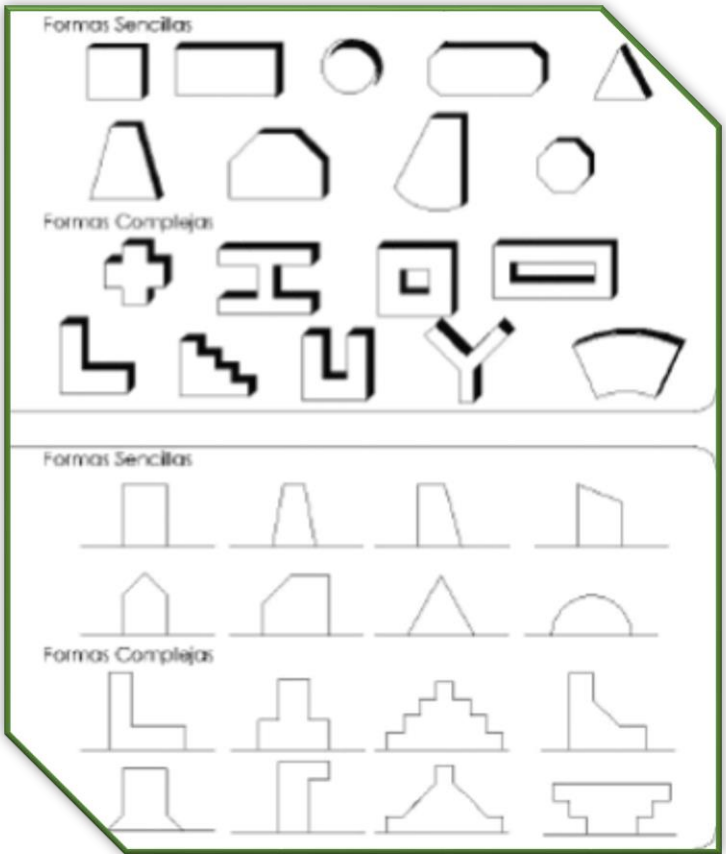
Formas Sencillas y Complejas en Planta y Elevación para Establecimientos de Salud. Fuente: OPS.
